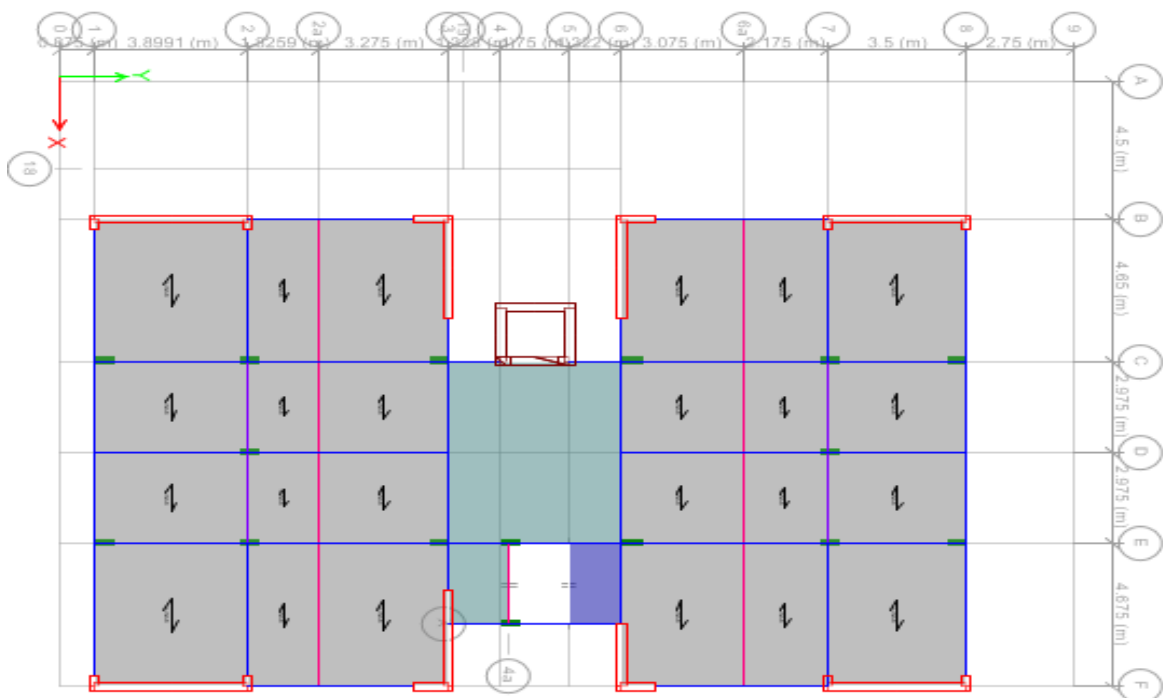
Planta Típica del modelado estructural del edificio(sentido de losas)
